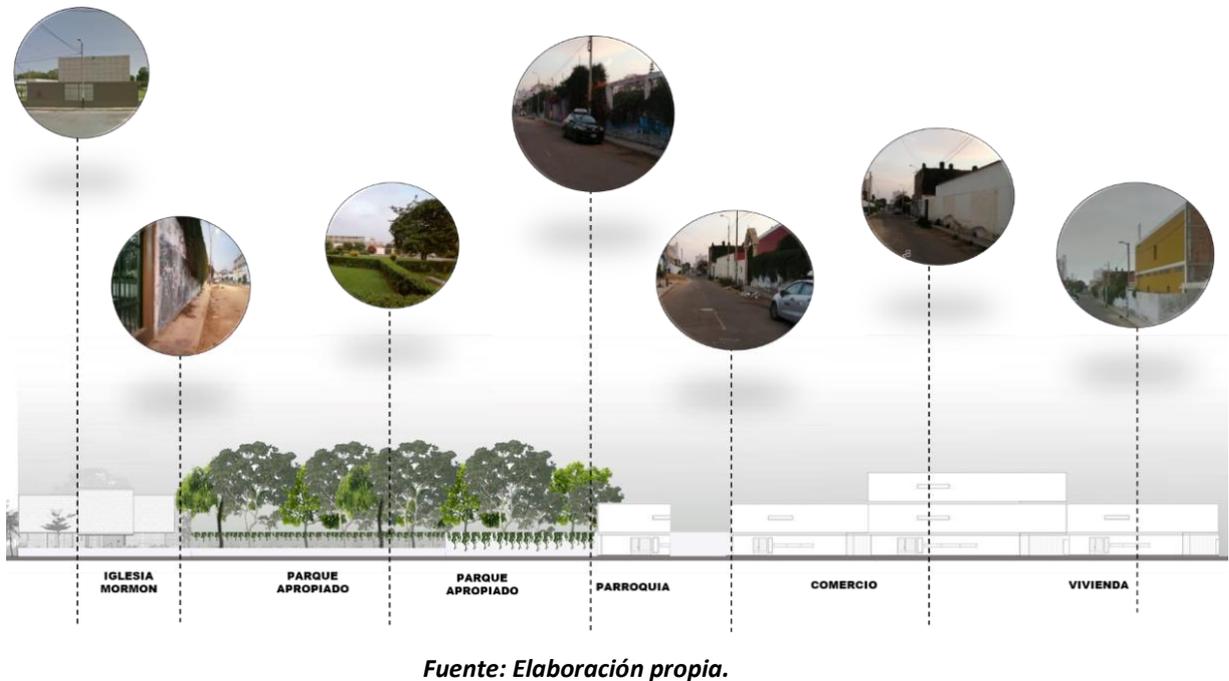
Perfil Urbano de la Calle Rebagliatti
